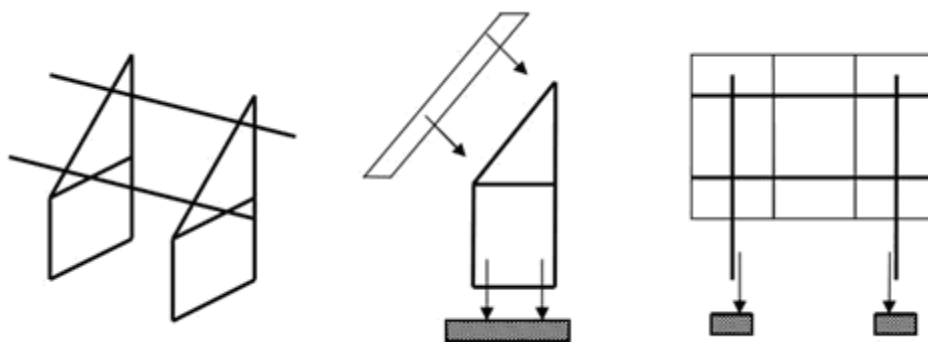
Схема опорной конструкции на цельной бетонной опоре
